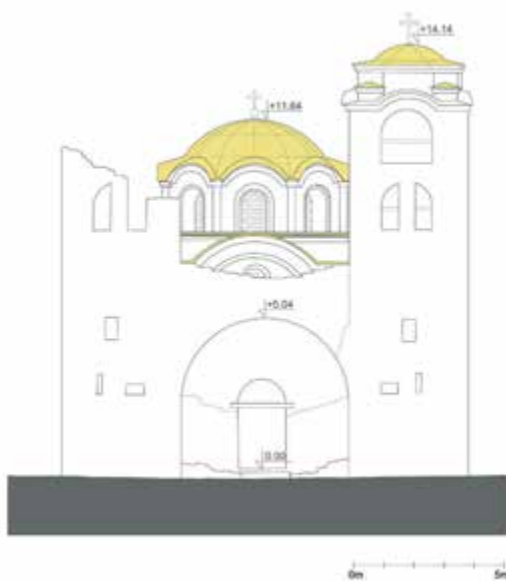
San Nicola. Prospetto ovest dopo il restauro
